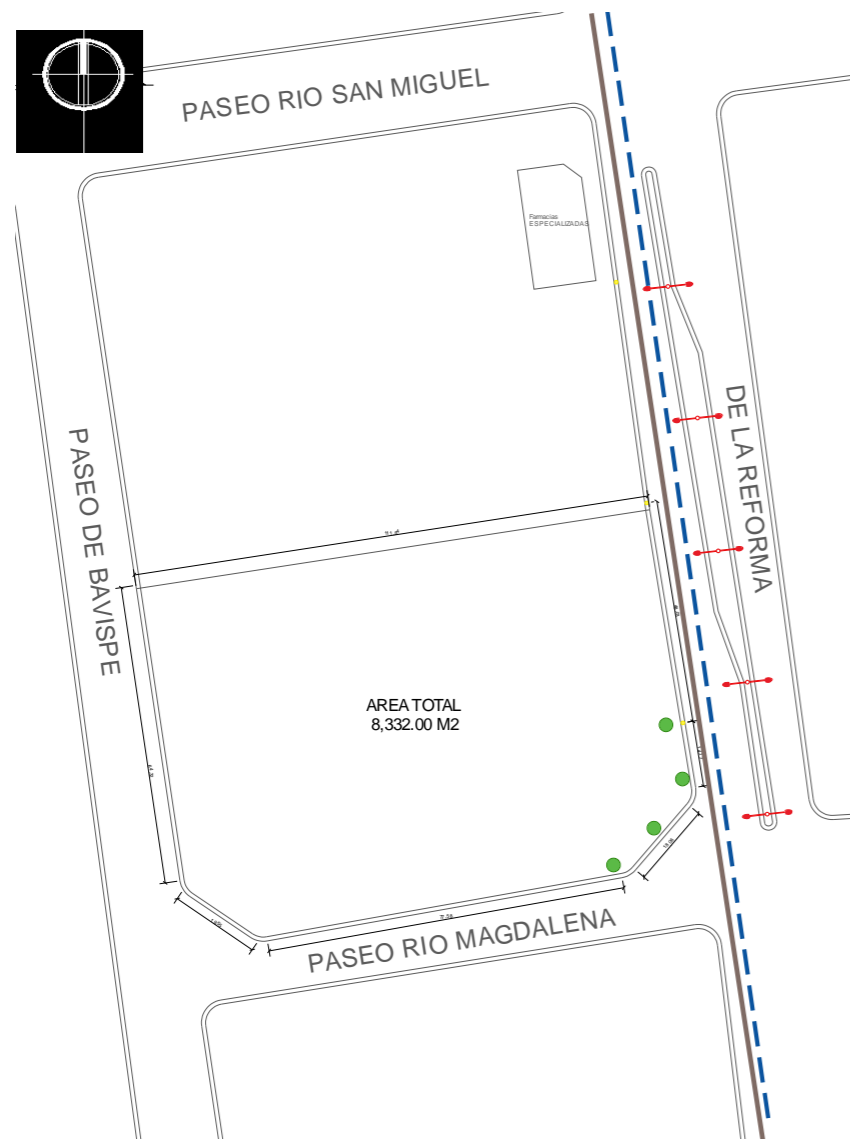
Infraestructura de Terreno S/E. Fuente Archivo Propio
